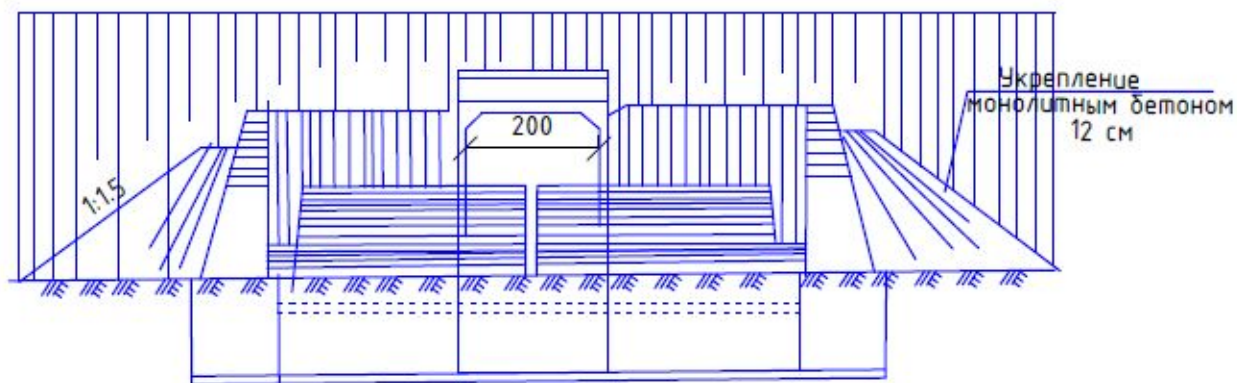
Фасад выходного оголовка ж/б трубы отверстием 2.0x2.0м.
